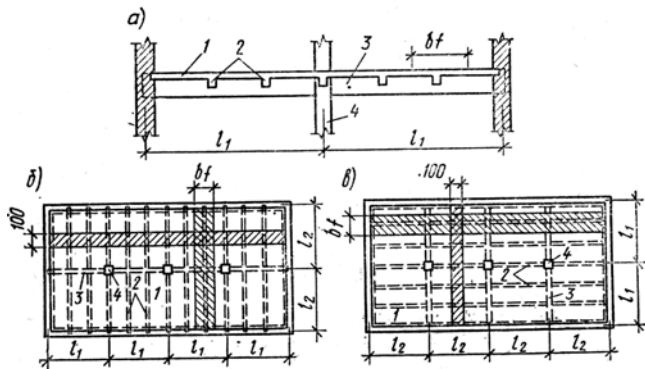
Конструктивные схемы монолитных ребристых перекрытий с балочными плитами:
